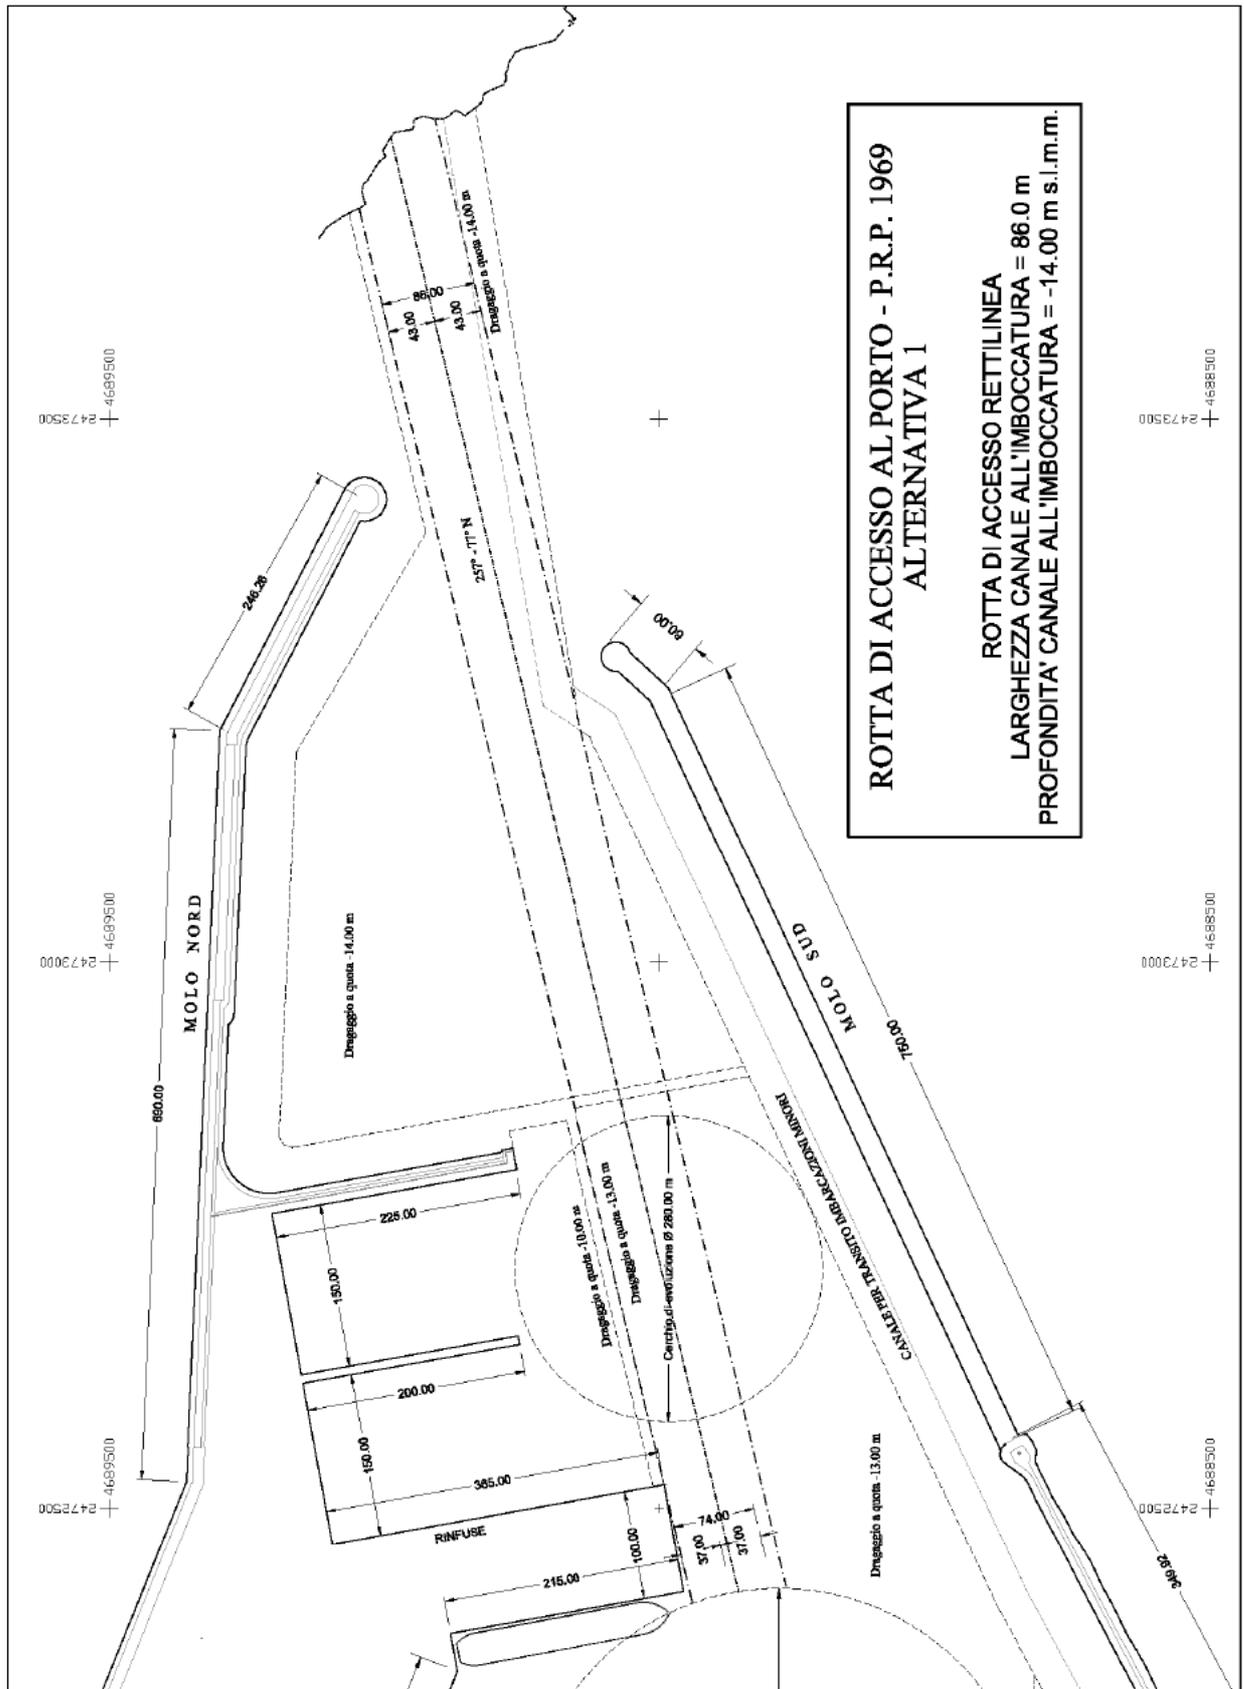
Canale di accesso al porto previsto dalla configurazione vigente (PRP 1969) – Alternativa 1.
